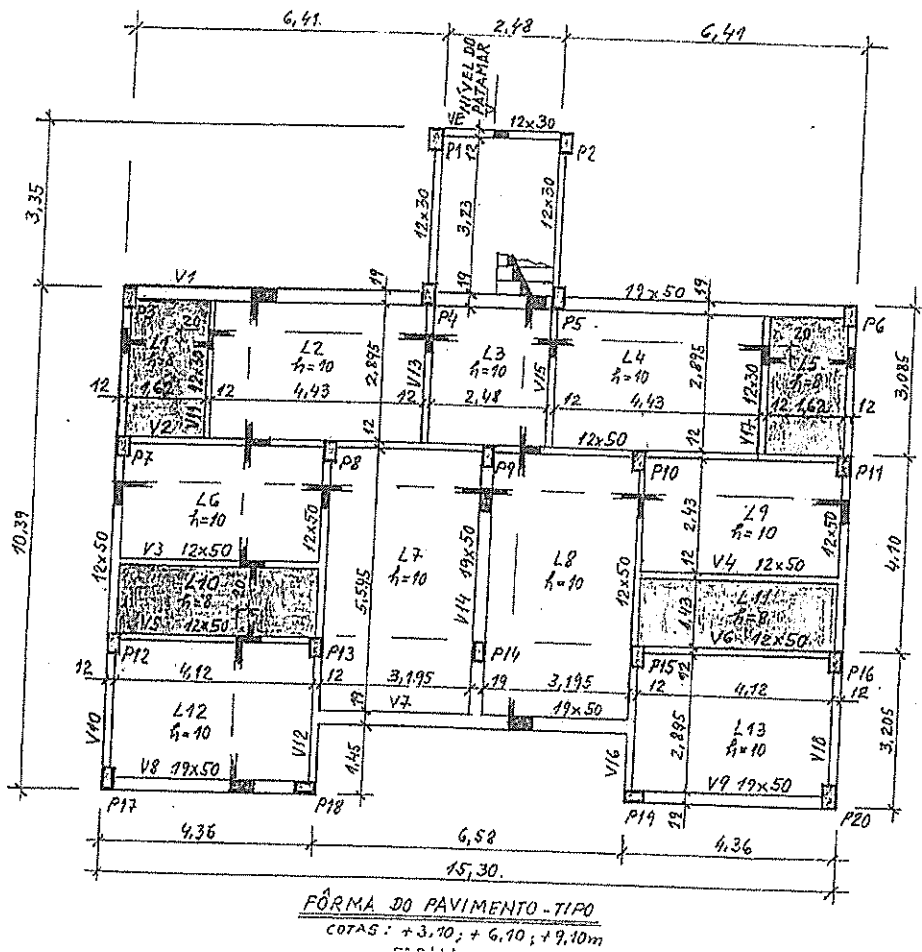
Desenho de fôrma da estrutura de um pavimento
